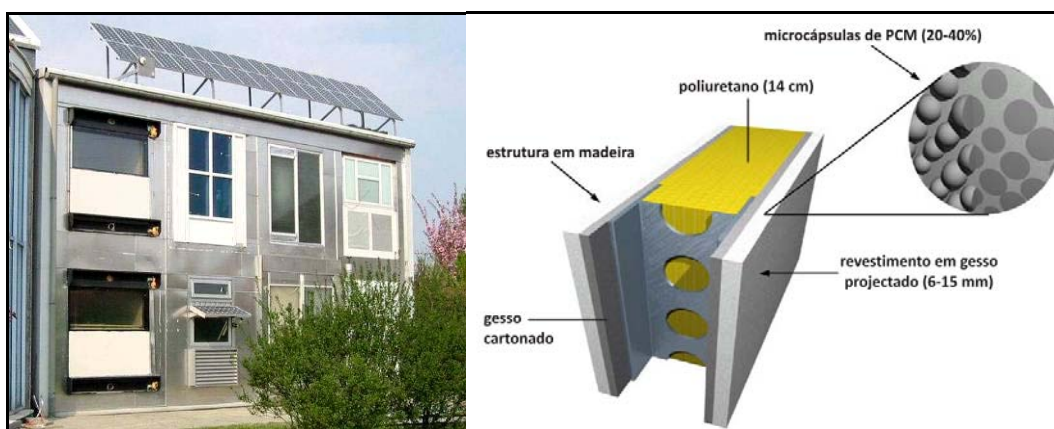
Exterior das células de teste e vista esquemática da estrutura da parede [39].
